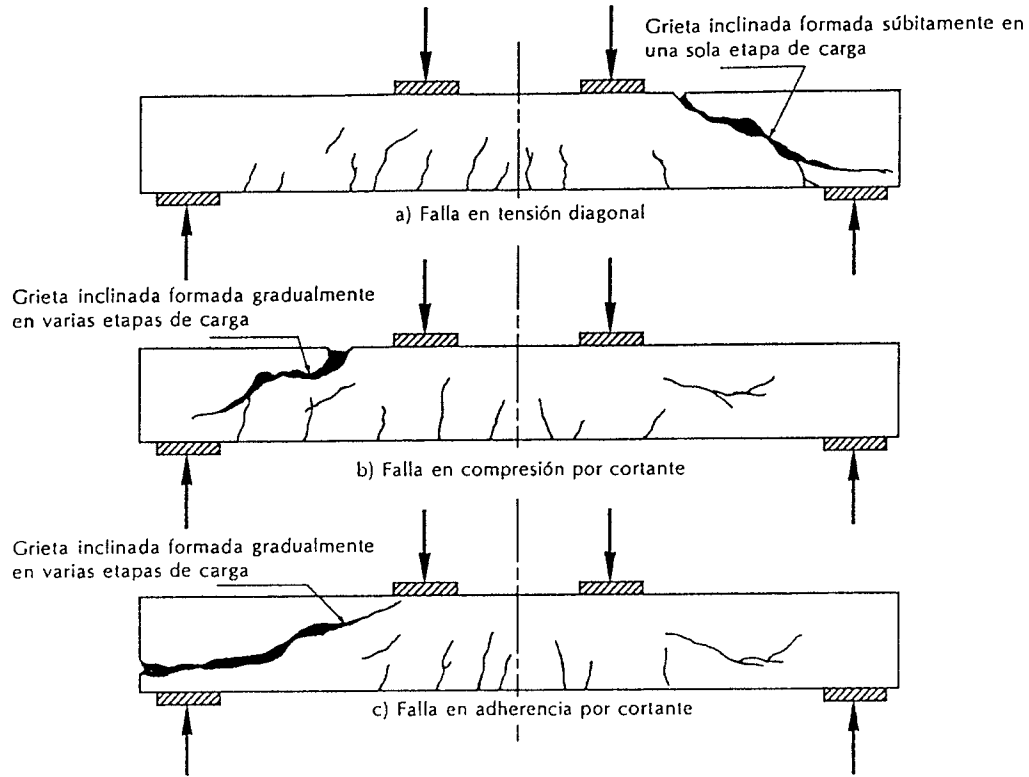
Principales tipos de falla en una viga sin refuerzo en el alma.
